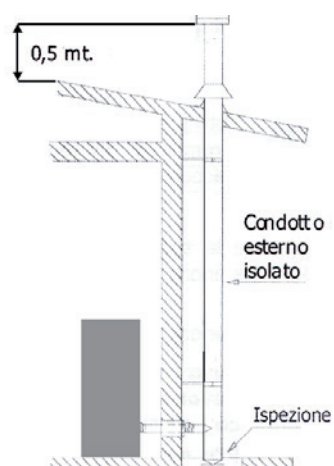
collegamento ad un condotto esterno con tubo isolato o doppia parete
